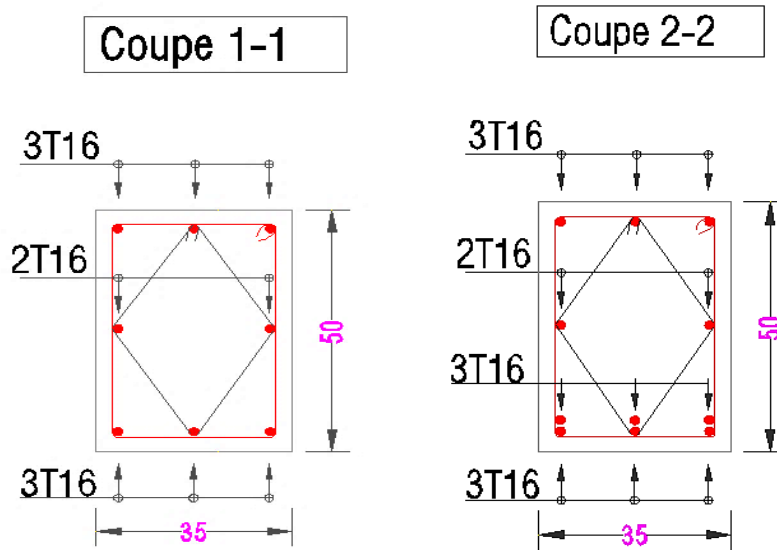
Schéma de ferrailage de la poutre palière des escaliers de trois volées
